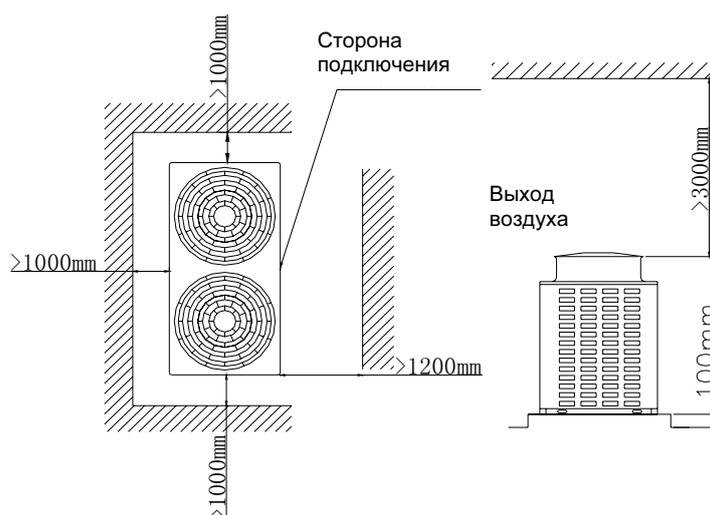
Требования по размещению наружных блоков с верхним воздуховыпускным отверстием
